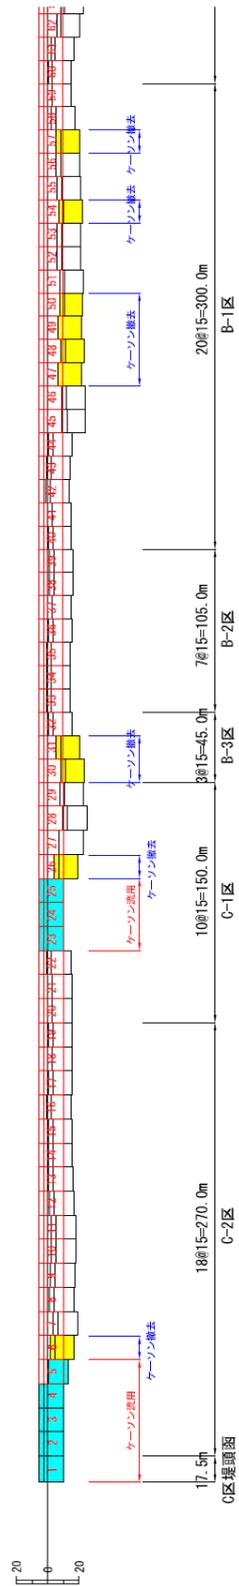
No.1 沖防波堤の断面図 B-1 区～C 区堤頭 (被災後・復旧後)
